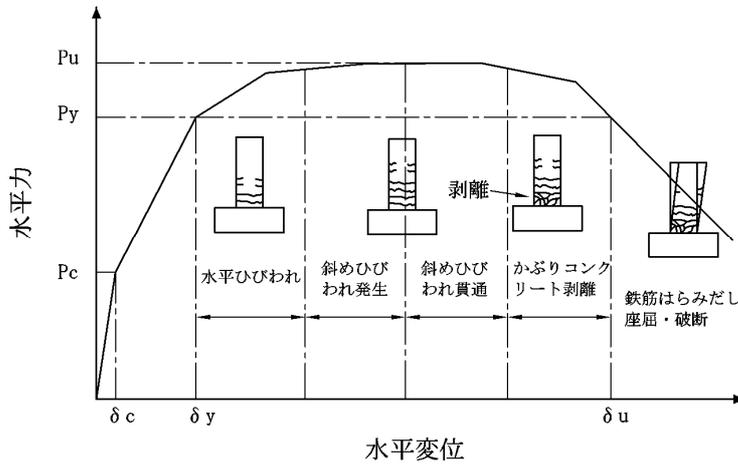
RC 橋脚の降伏以降の損傷状況
